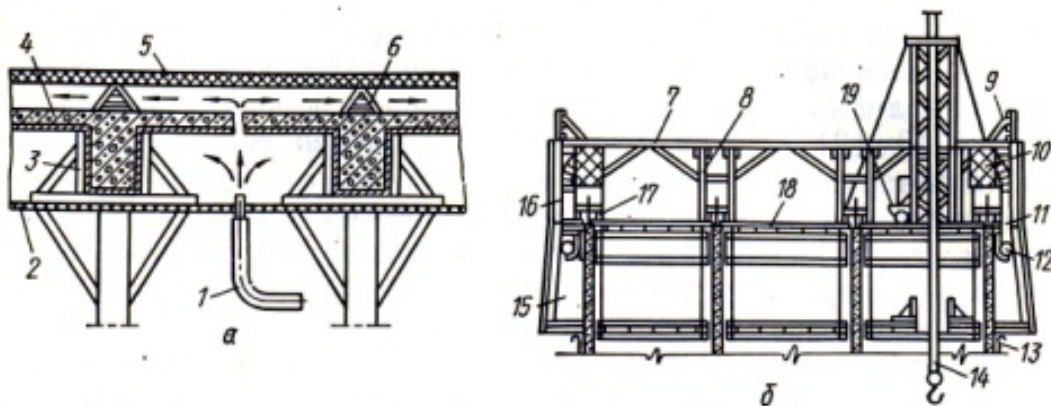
Схемы паропрогрева и воздухообогрева:
